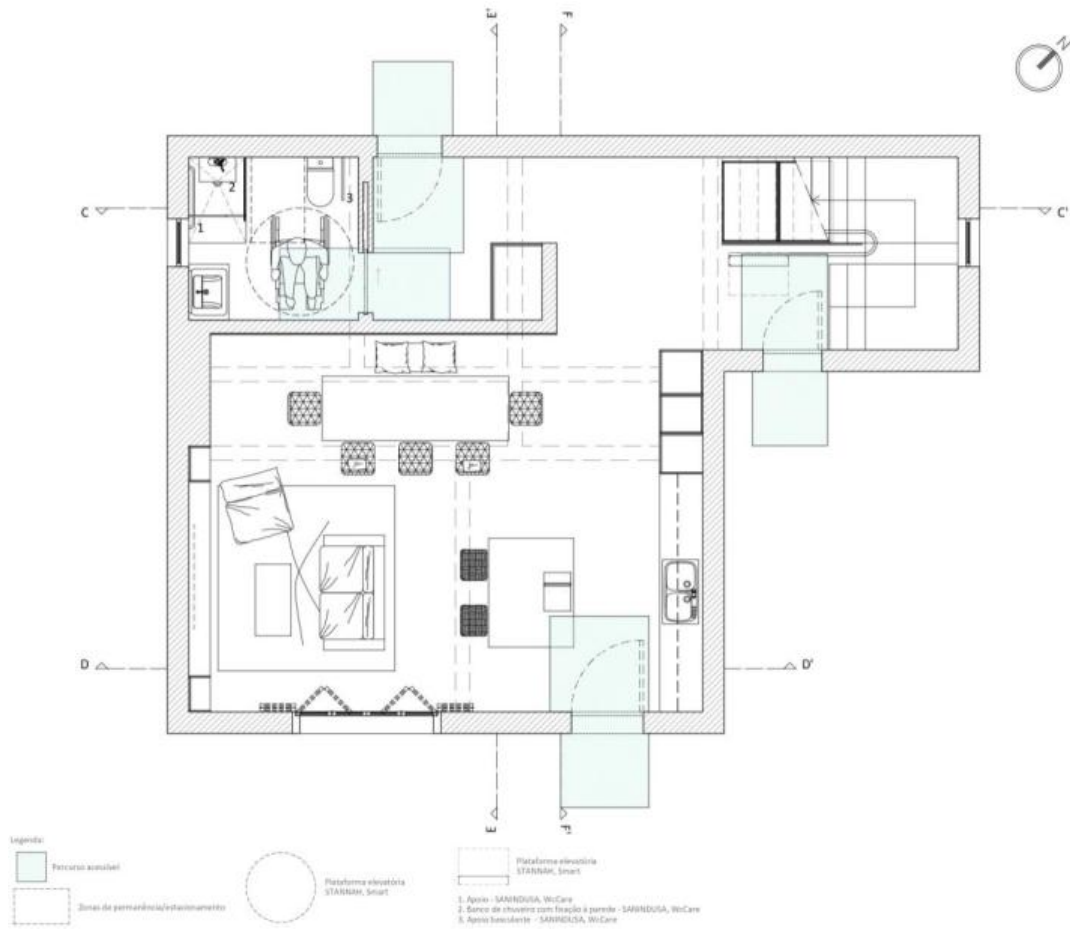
Planta de Acessibilidades, Piso 0. Fonte: Autor
